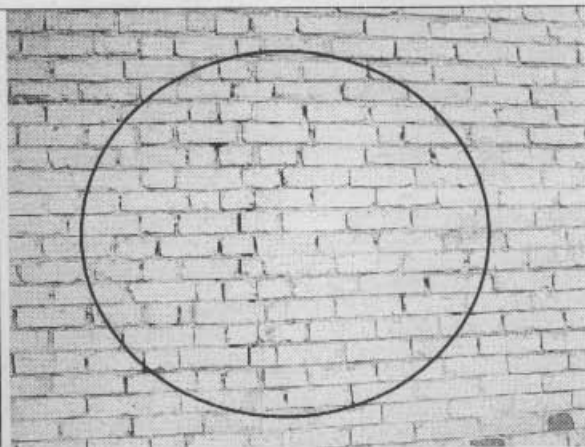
Agrietamientos verticales en algunos tramos del muro.
